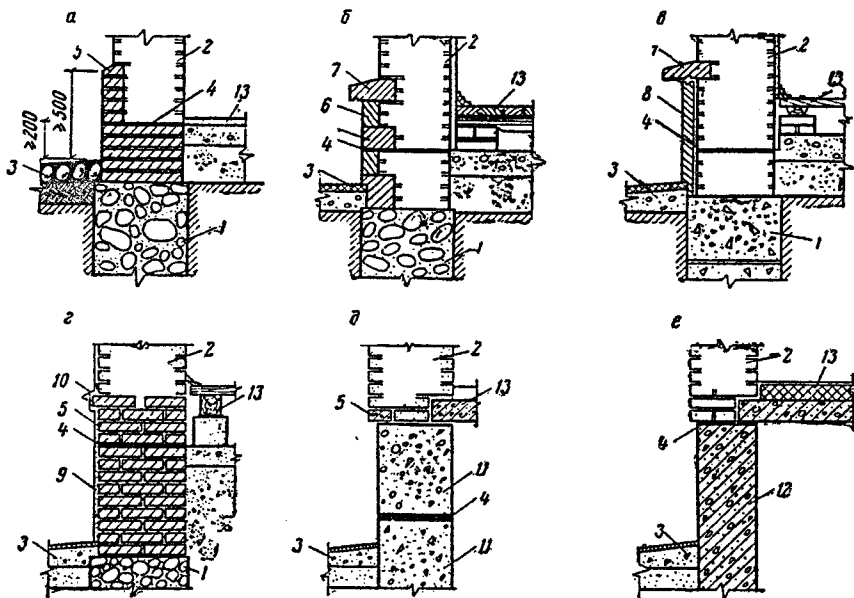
Типи конструкцій цоколів: а – обкладений цеглою; б – обкладений камінними блоками; в – обкладений плитами; г – оштукатурений; д – з бетонних блоків; е – з залізобетонних панелей; 1 – фундамент; 2 – стіна; 3 – відмощення; 4 – гідроізоляція; 5 – цегла; 6 – цокольні кам'яні блоки; 7 – бортові цокольні камені; 8 – облицювальні плити; 9 – штукатурка; 10 – покривельна сталь; 11 – бетонний блок; 12 – панель фундаментної стіни; 13 – конструкція підлоги першого поверху.
